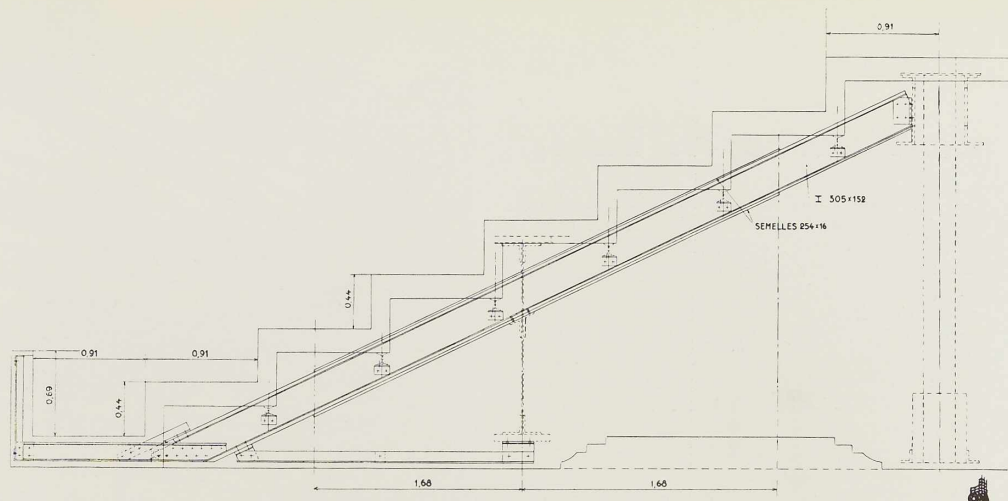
Schéma d'une poutre secondaire du Dominion Theatre de Londres
